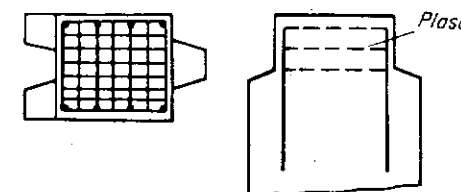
Detaliu de cap al palplanșelor din beton armat.
